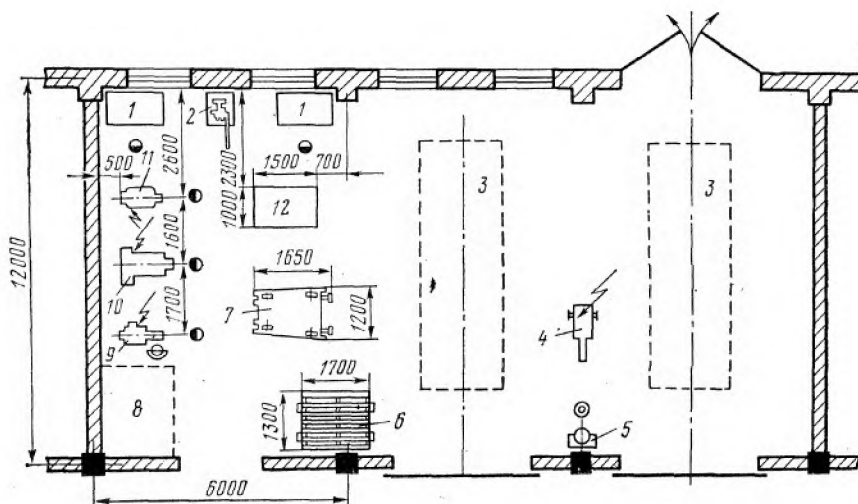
Сварочно-жестяницкое отделение ПАТ:
